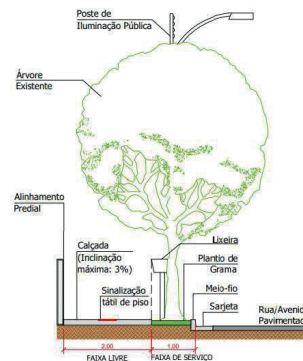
Seção transversal do detalhe de calçada modelo de 3 metros de Cianorte. Fonte: Plano Diretor, 2022.
